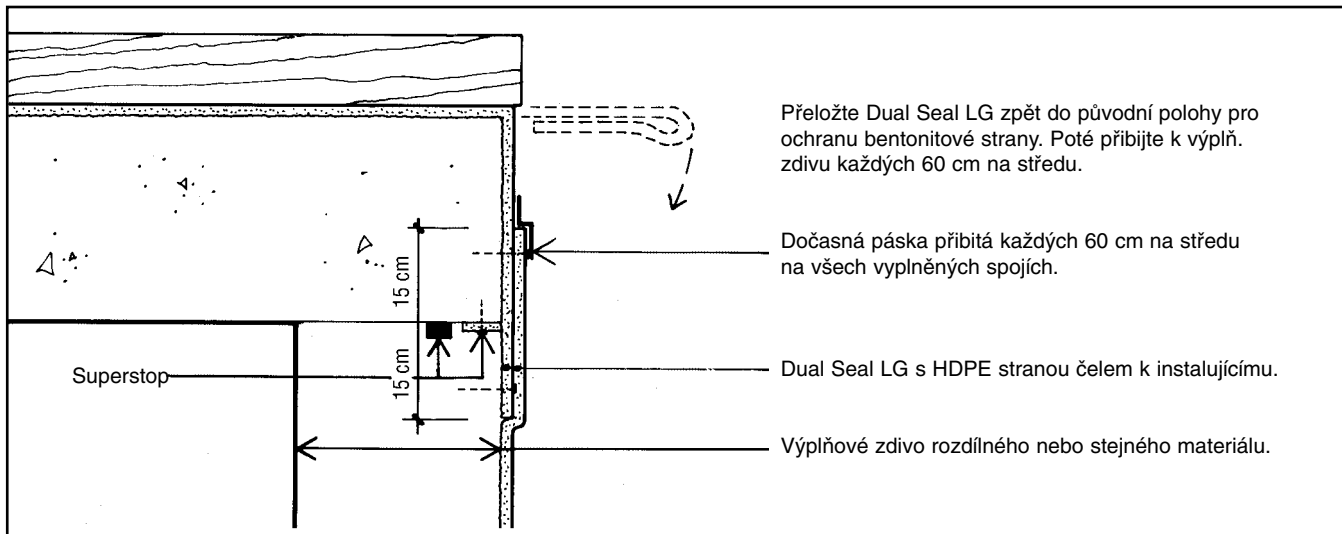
Instalace Dual Seal LG na betonový pilíř – půdorysný pohled.
